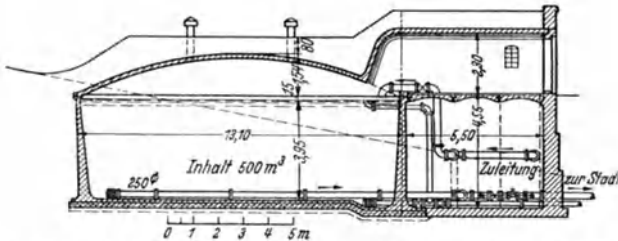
Kreisrunder zweikammeriger Stahlbetonwasserbehälter der Stadt Brüg. (Verfasser.)
